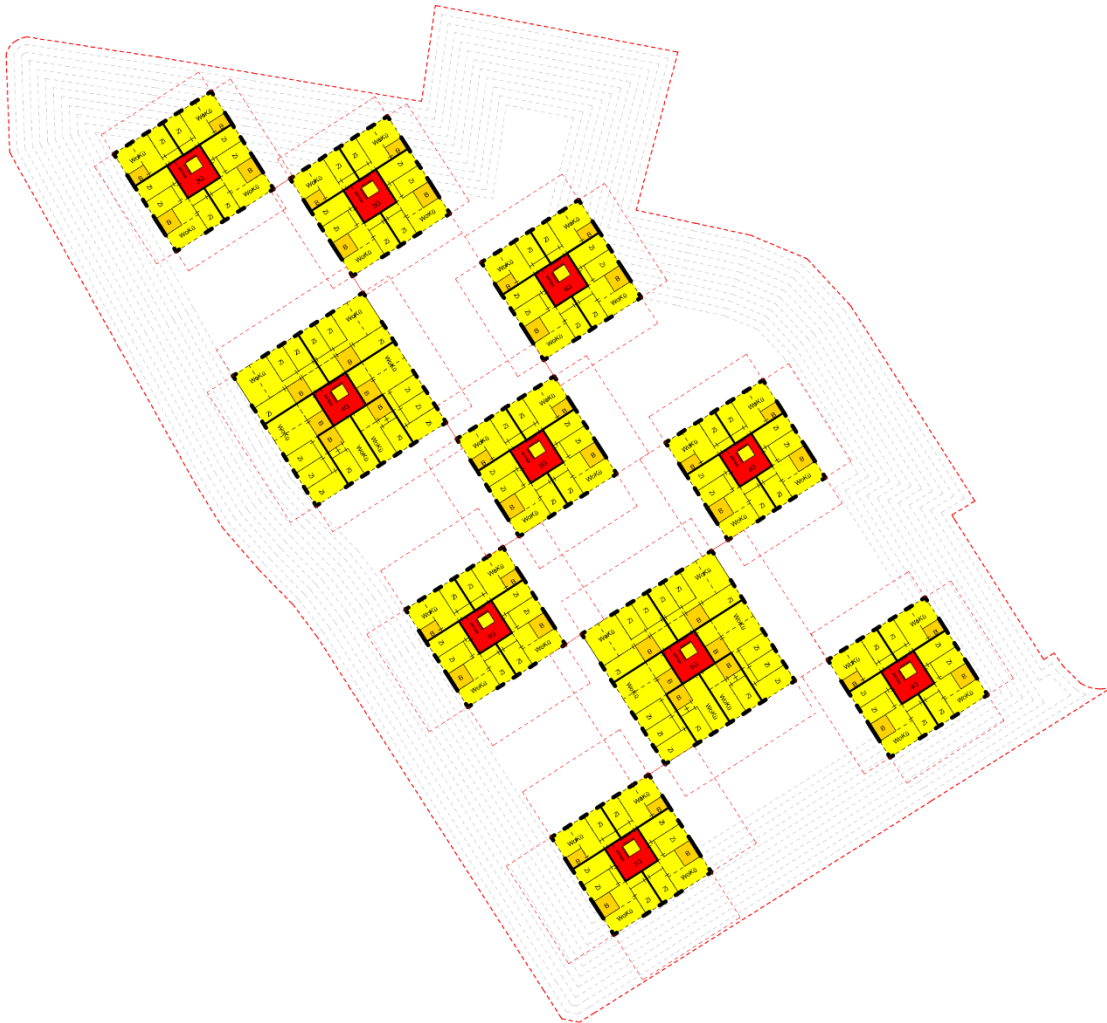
Tallinner Straße Variante Punkthaus – Regelgeschoss
